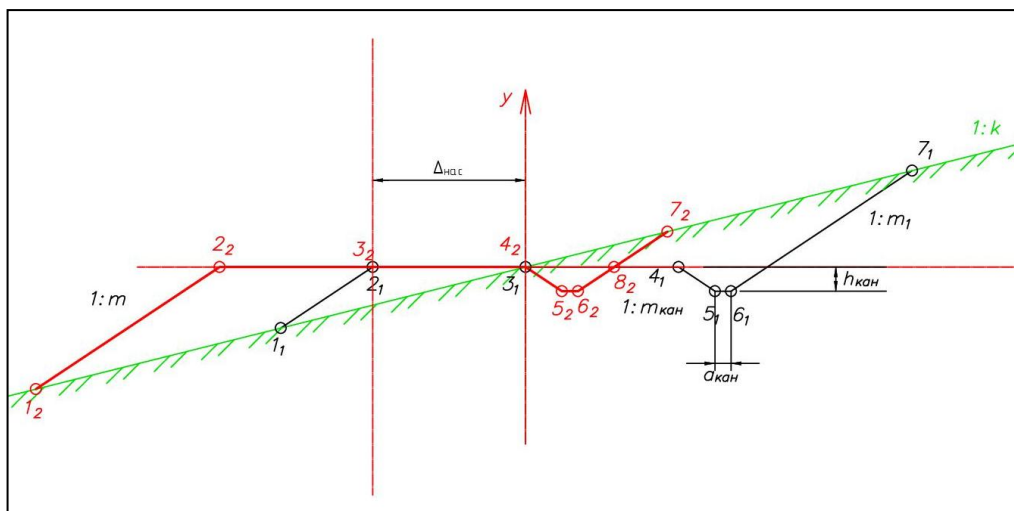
Схема расчёта варианта смещения оси трассы в плане в насыпь.
